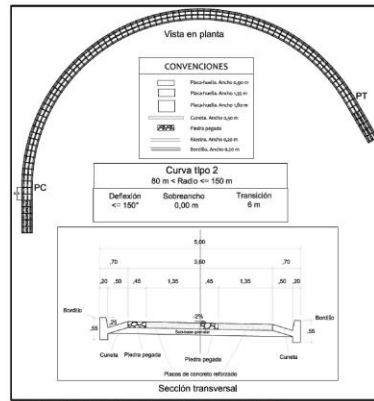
Vista en planta y perfil de la sección transversal en curvas TIPO 2 Δ ≤ 150° y 80 m < R ≤ 150 m
